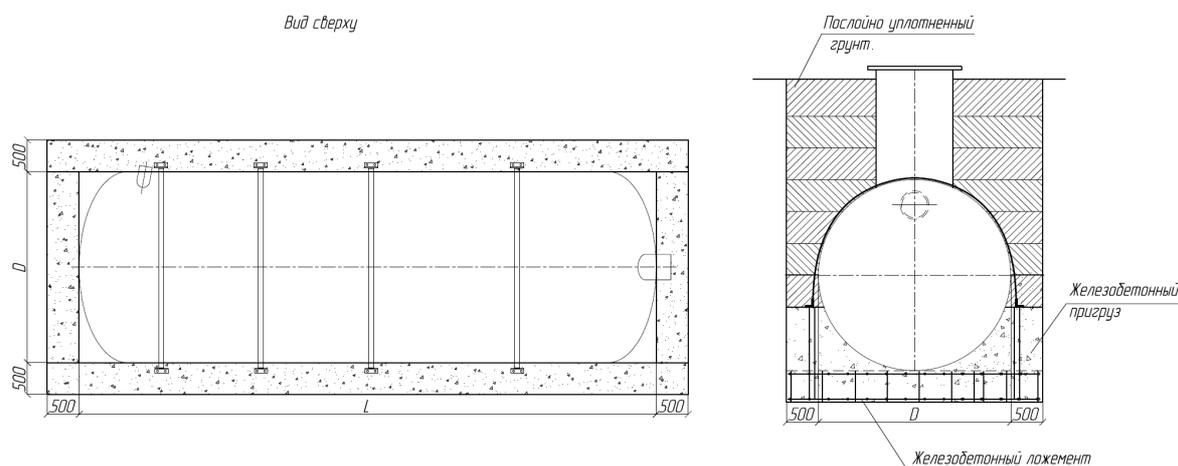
Пример монтажа оборудования при высоком уровне грунтовых вод
